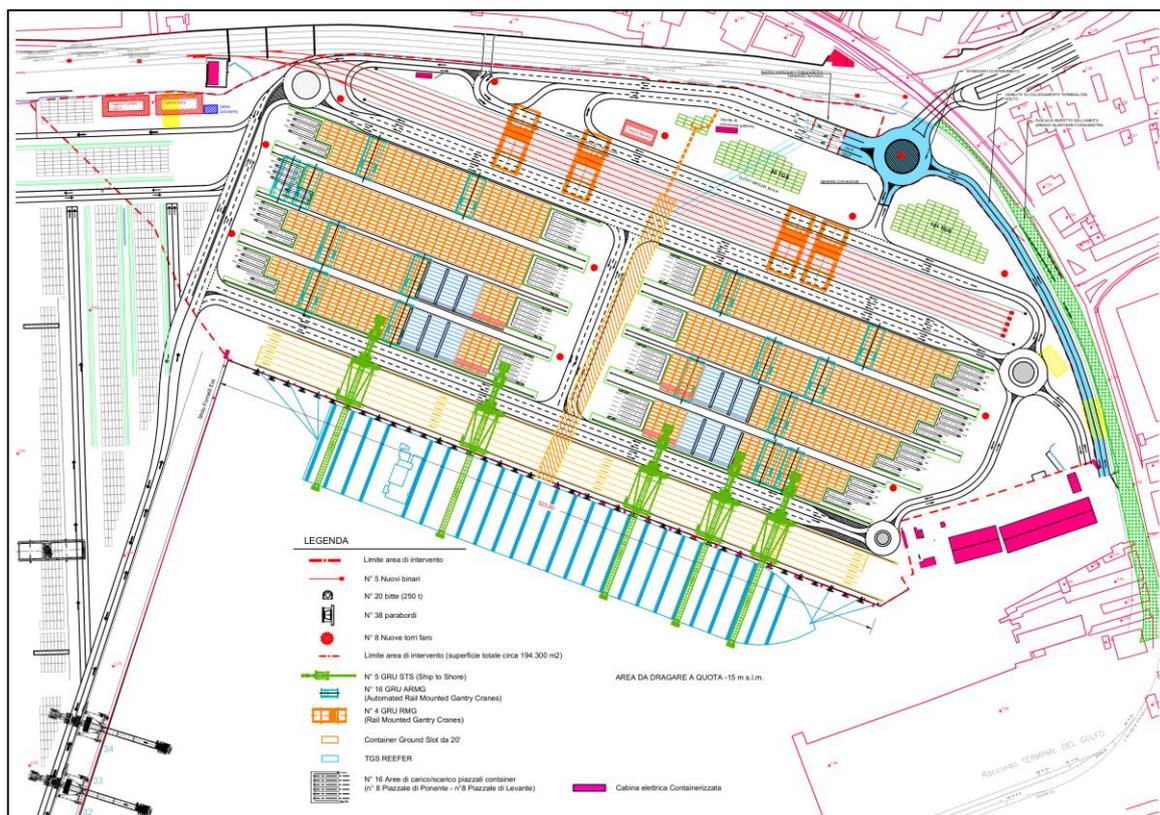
Nuovo terminal Ravano - Planimetria di progetto
